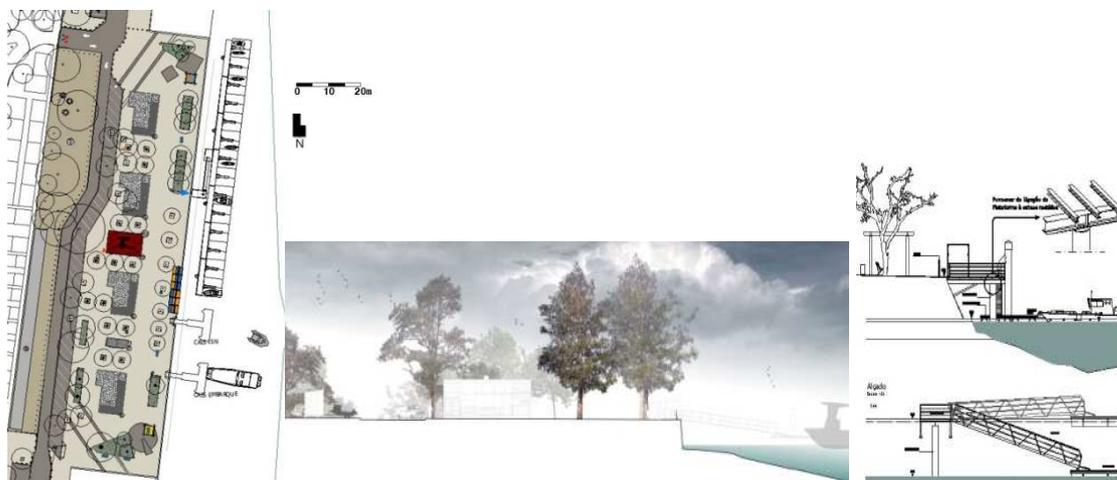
Planta de pormenor da zona dos bares. Corte e pormenores das soluções ligação terra-canal. Flutuadores. (s/Esc.,base Esc. 1/200 e outras).
